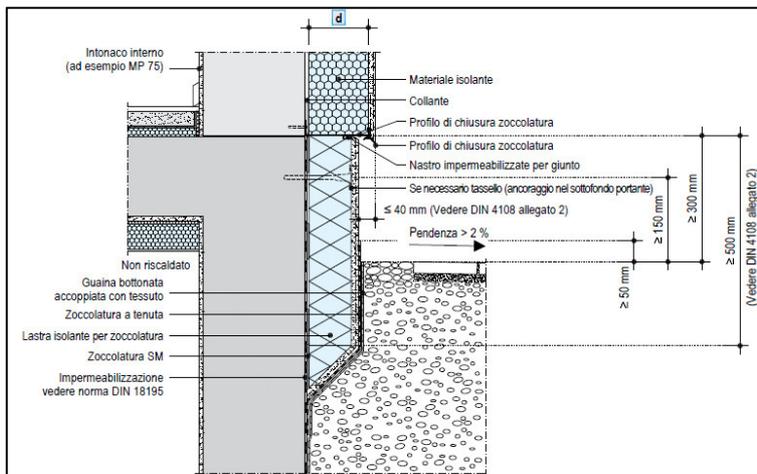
Dettaglio: nodo di fondazione con zoccolatura rientrante
